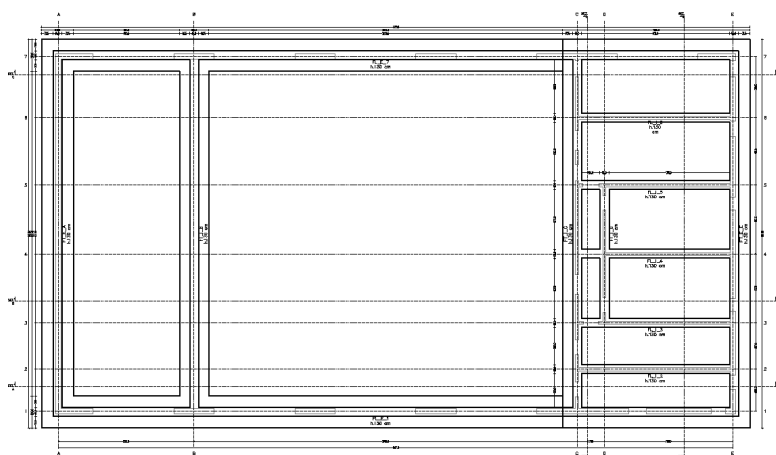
Pianta setti p.1 palestra: strutture in progetto
